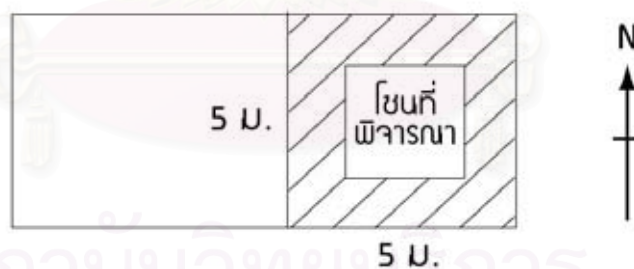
Floor Plan แสดงลักษณะของโชนตัวอย่างที่ 1
